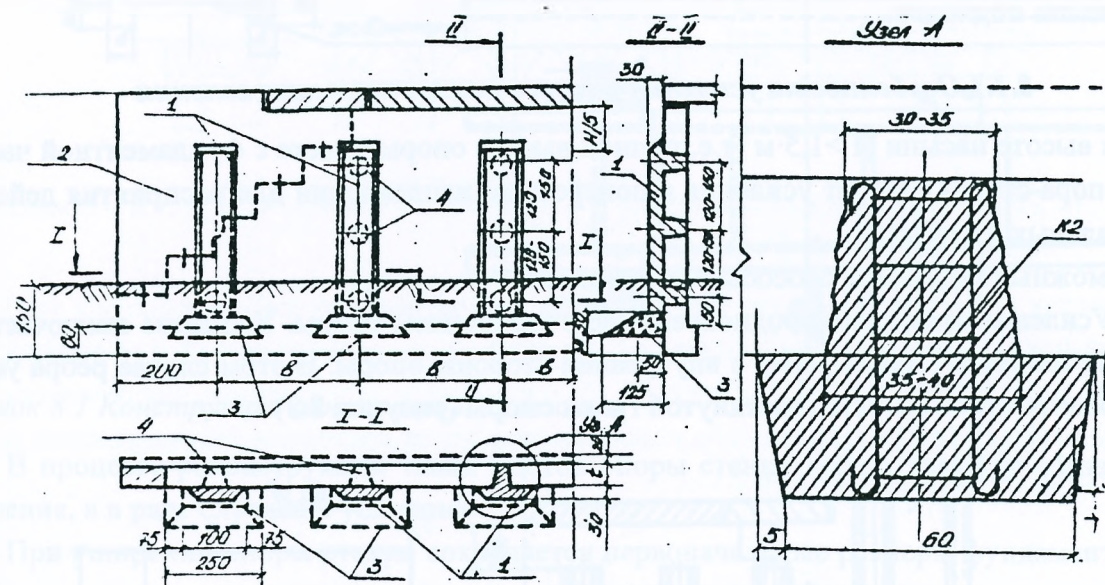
Усиление опоры-стенки с внешней стороны бетонными ребрами: 1 – бетонные ребра усиления; 2 – уширенная часть опоры; 3 – опорная щебеночная призма.
